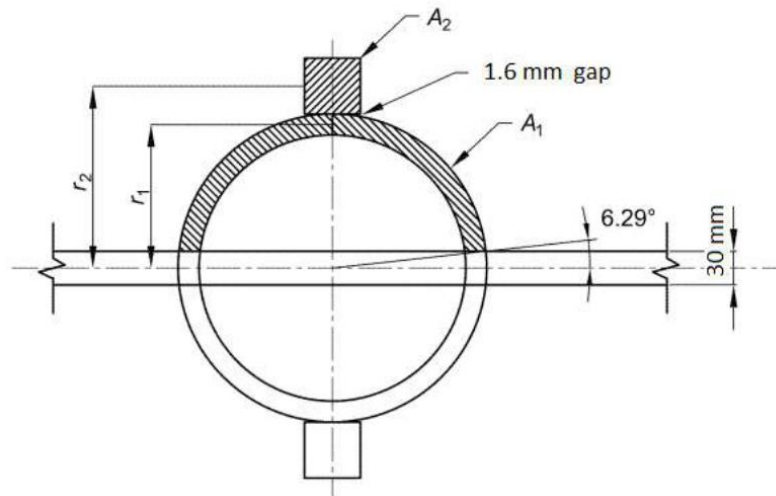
Sección transversal del arriostramiento inferior de la viga.
